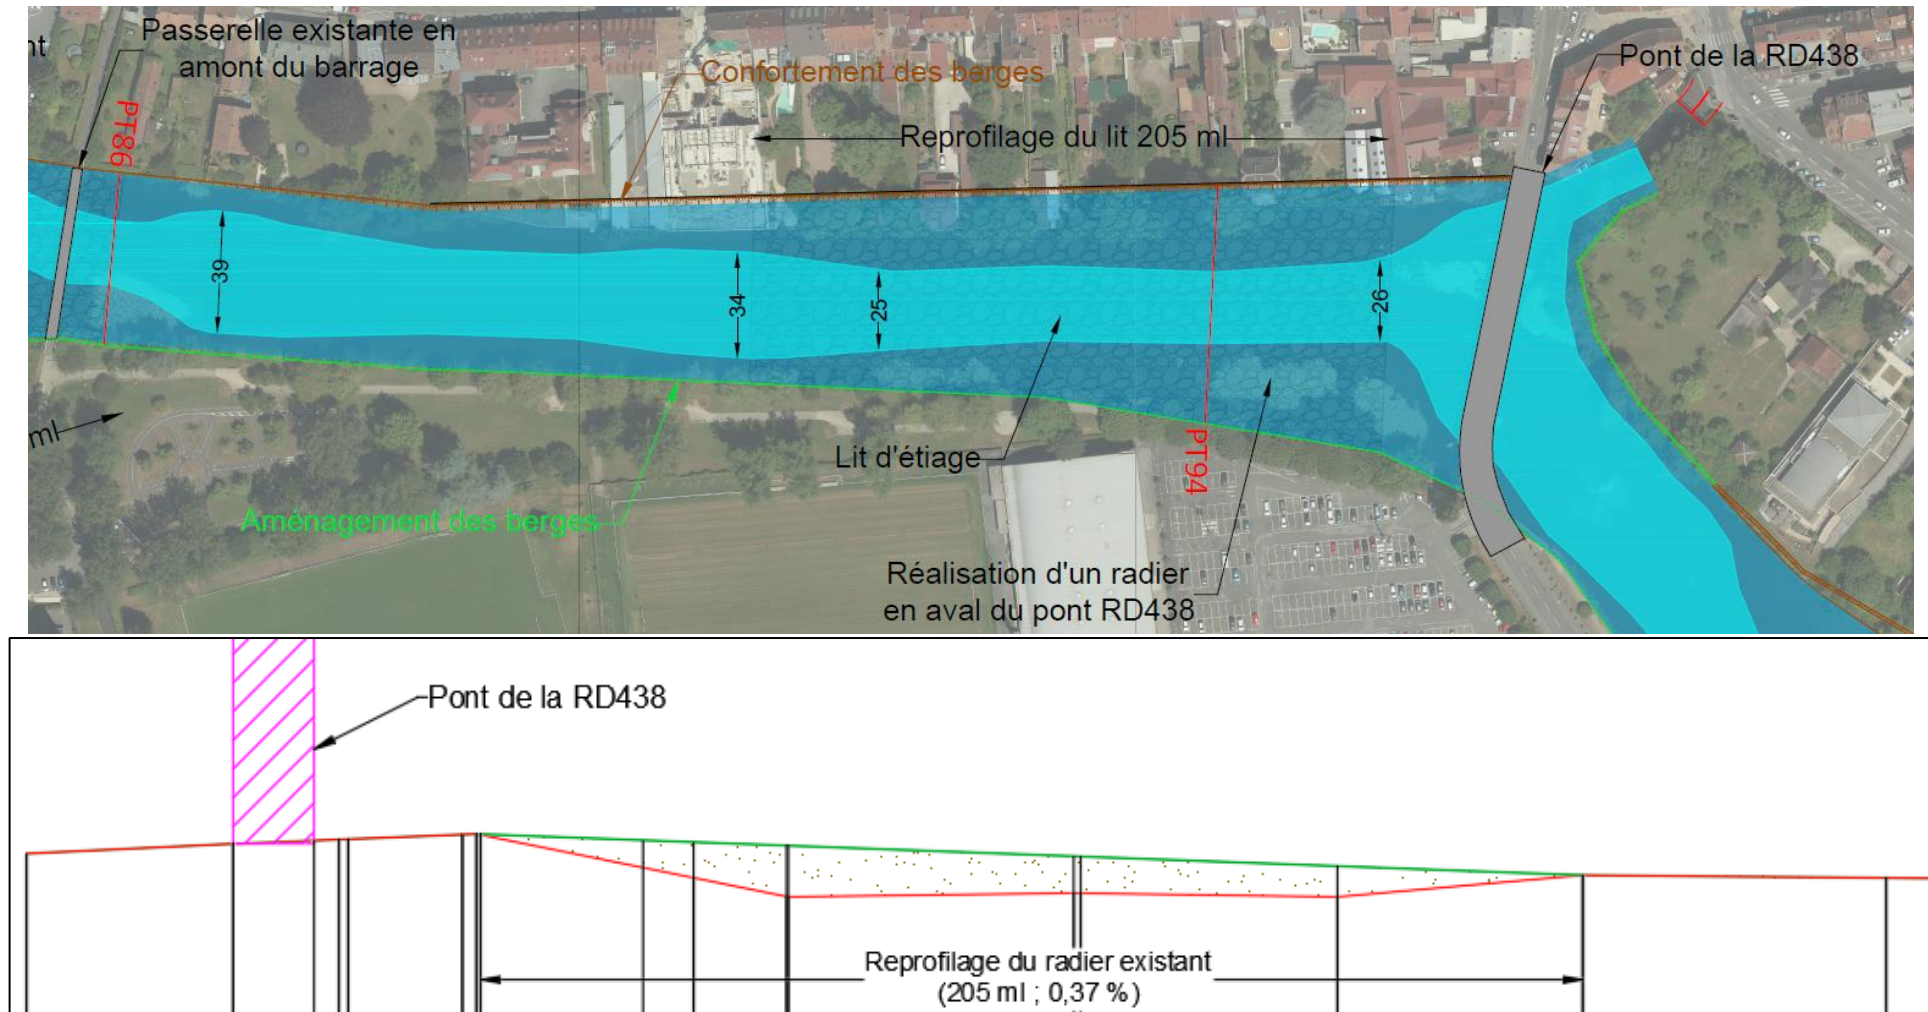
Plan de masse et profil en long au droit du radier de la D438 (scénario RCE1)
